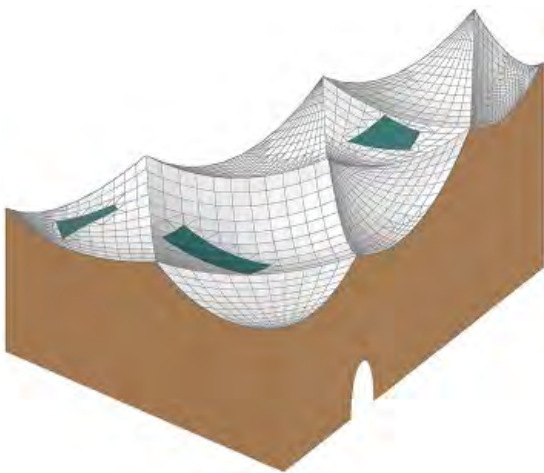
Struktur des Gebäudedaches (© spannverbund GmbH)
